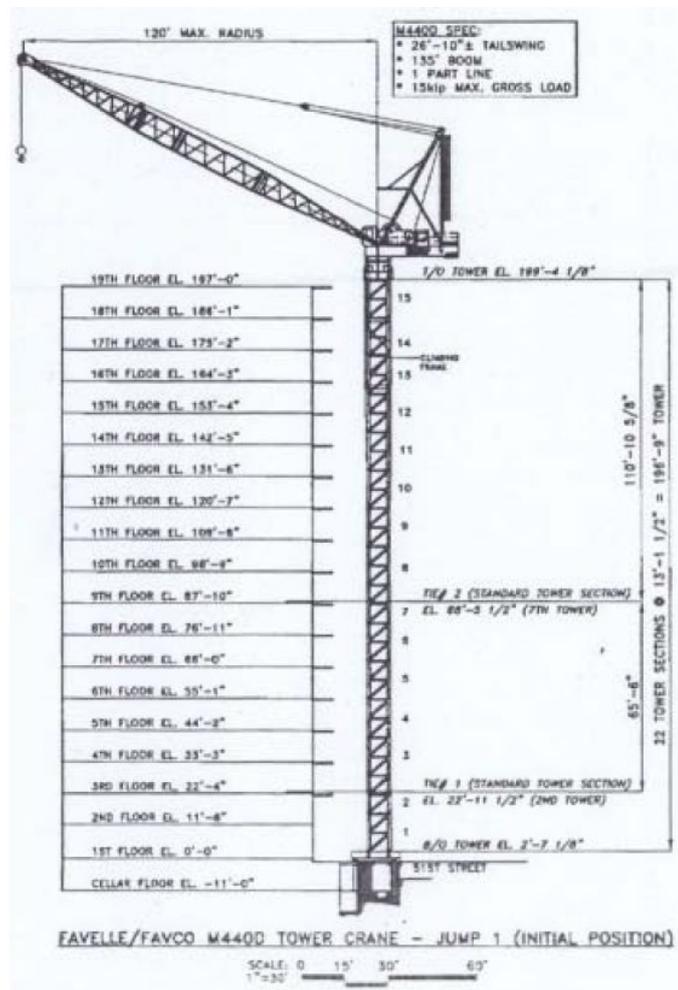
Gru autorampante Favelle Favco M440E [29]
